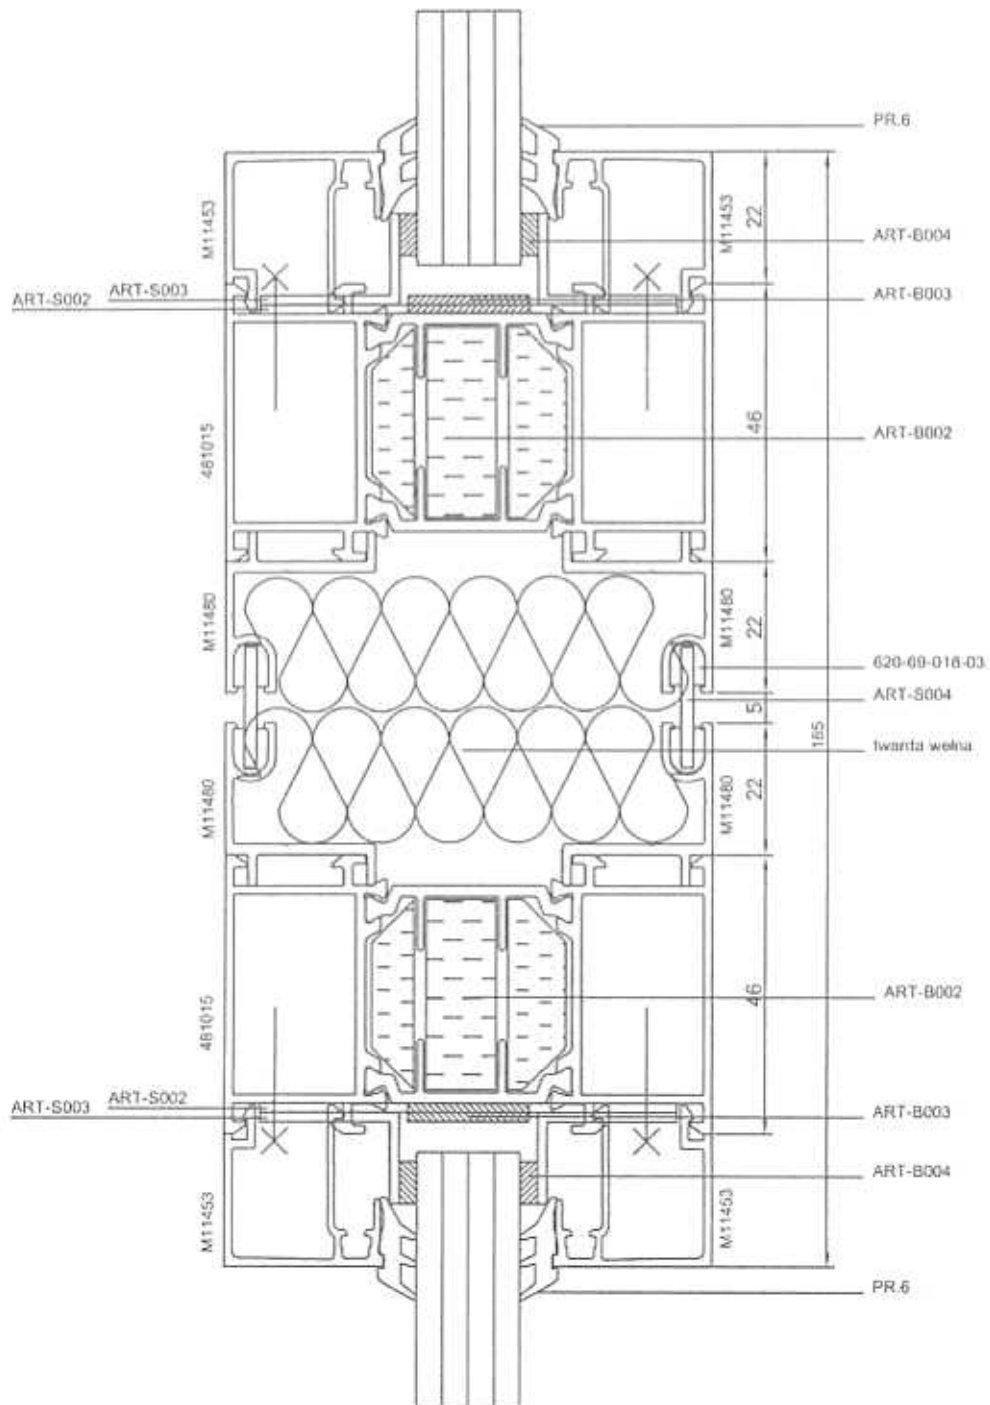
Przekrój 7-7 segmentu ścian wewnętrznych odmian ALUFIRE EI 15 i ALUFIRE EI 30 (przekrój przez element pionowy ramy)
